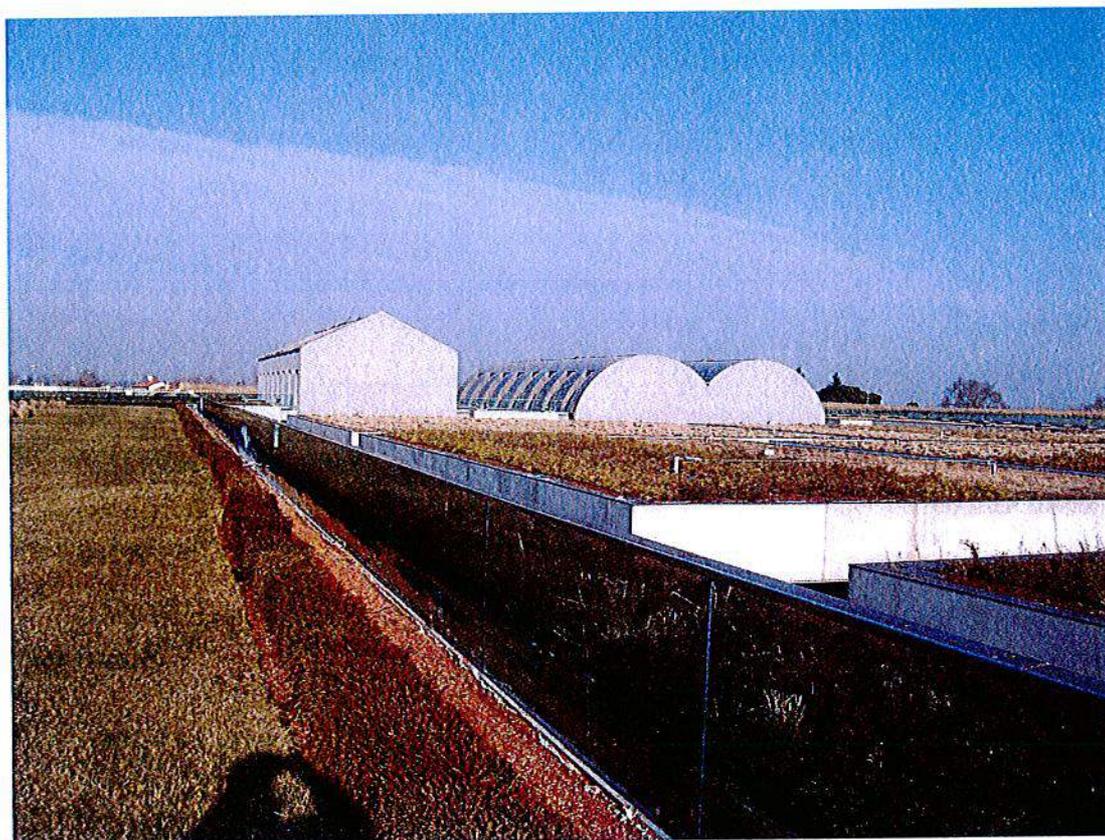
Stato di fatto del solaio del piano terreno.
